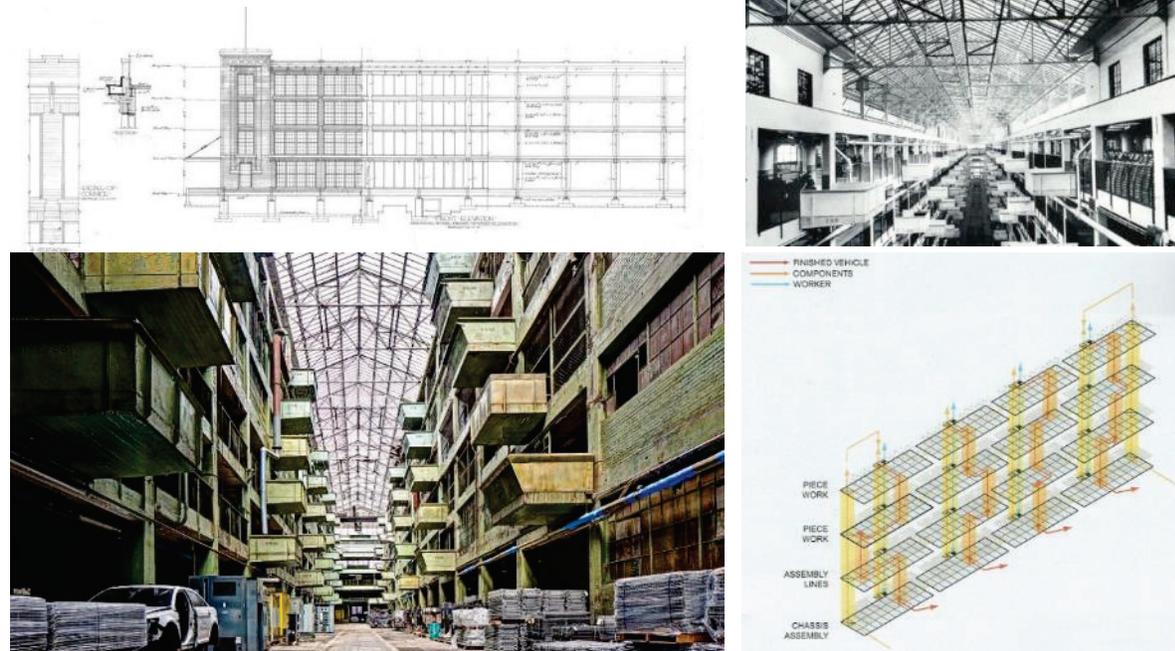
Highland Park, Fassade, Grundriss und Querschnitt, Bentley Hist. Library
